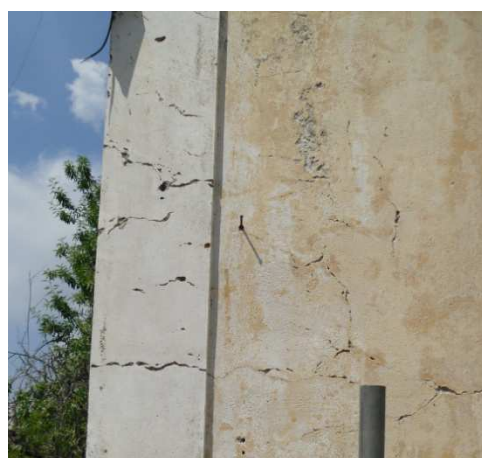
Fissuração, destacamento e empolamentos do reboco tradicional nas fachadas exteriores.
